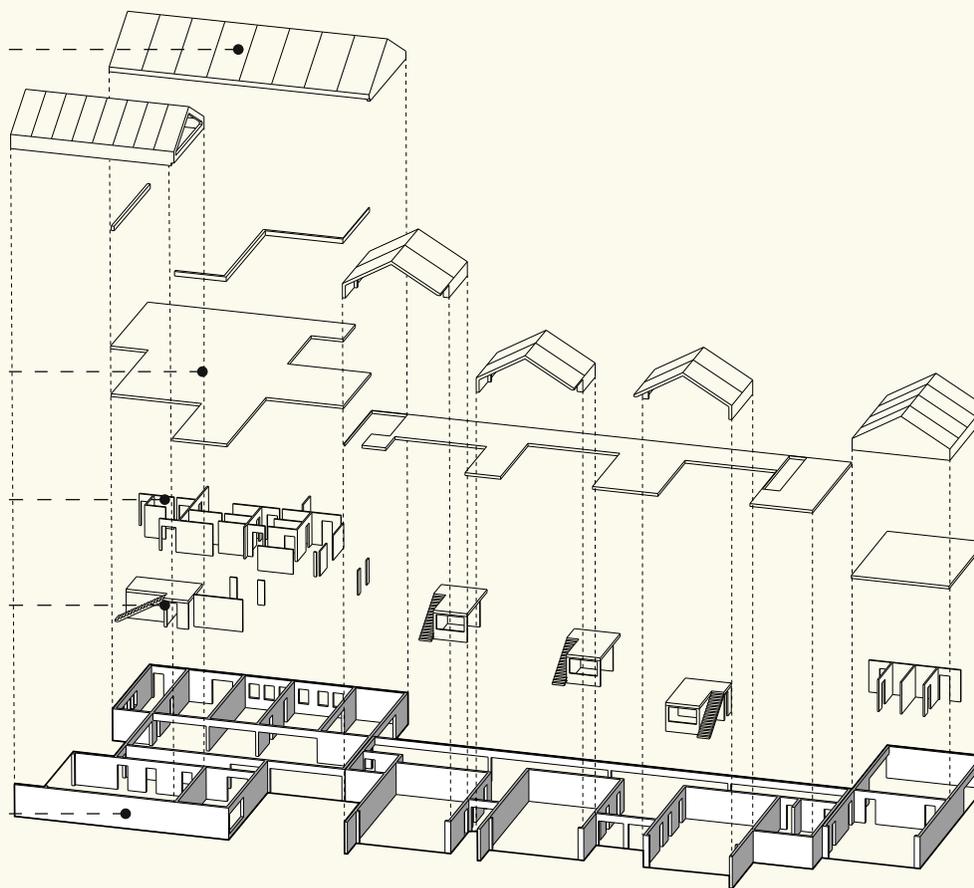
, axonometrische Darstellung – tragendes Grundgerüst des Kindergartens
